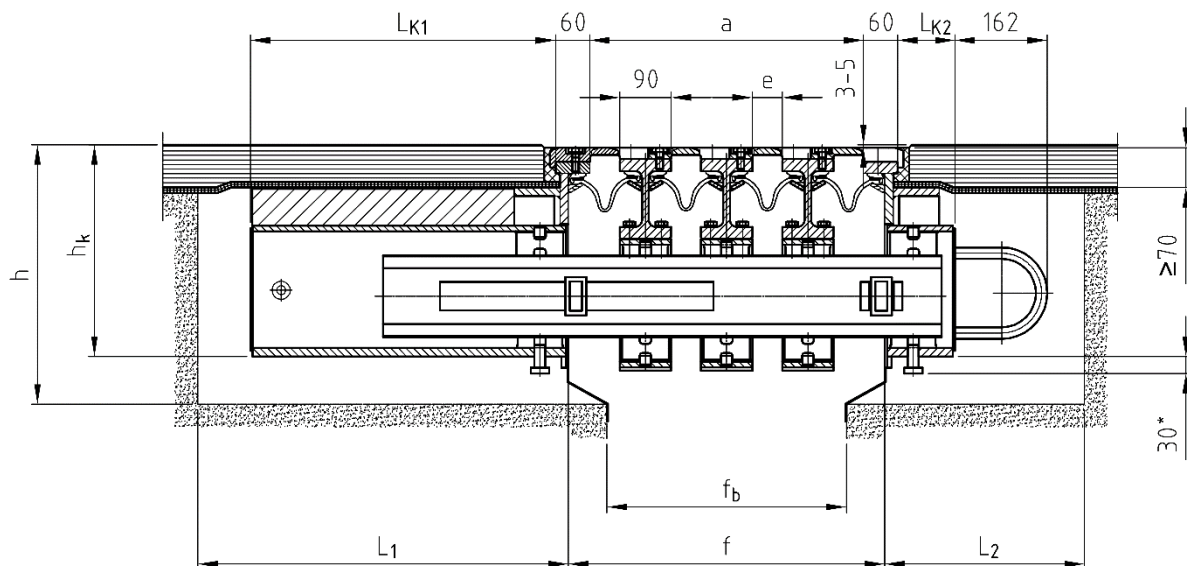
Situation und Bezeichnungen zu den Aussparungsabmessungen
